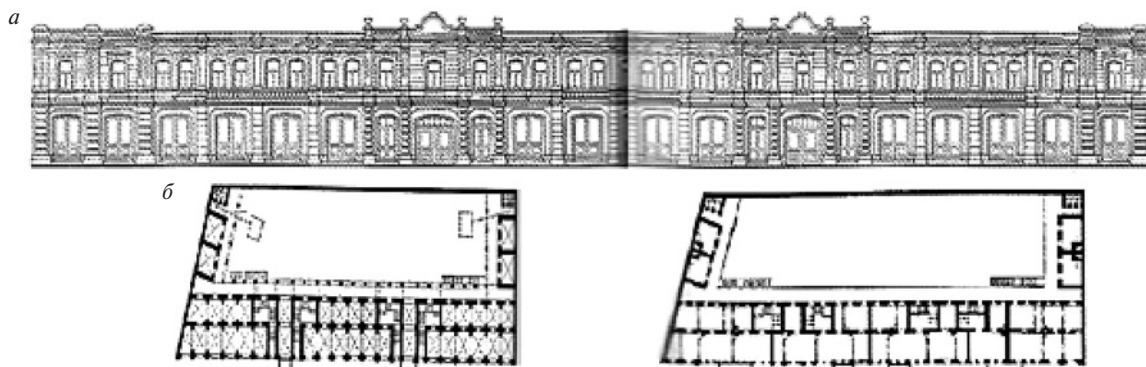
Проект жилого дома Солтанова на Биржевой площади (сквер Азадлыг): а – фасад; б – планы этажей. Арх. М.М. ГафарИсмаилов
